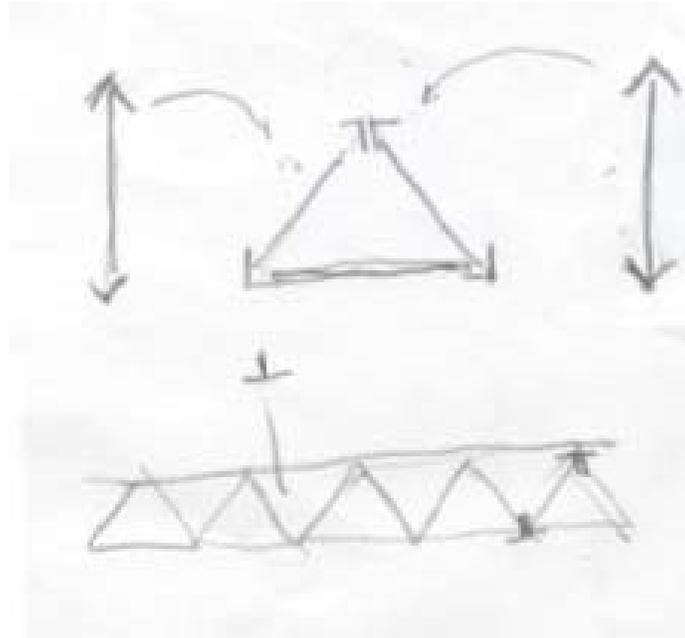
Sistema de Cantoneiras Soldadas
